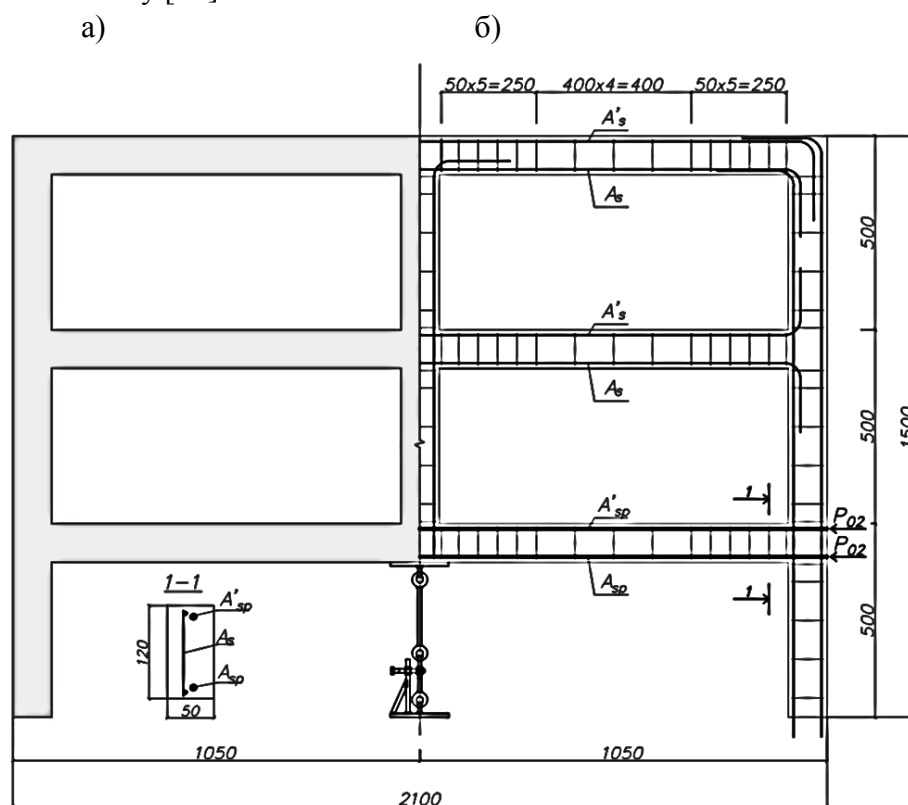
Схема опалубки (а) и армирования (б) конструкции рамы
